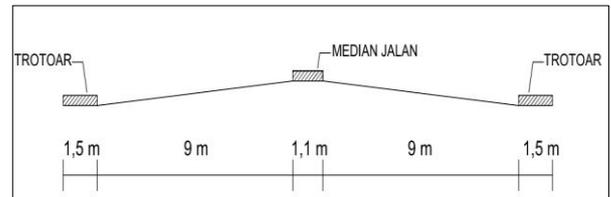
Geometrik Melintang Jalan A. Yani Setelah Peningkatan Struktur Badan Jalan
